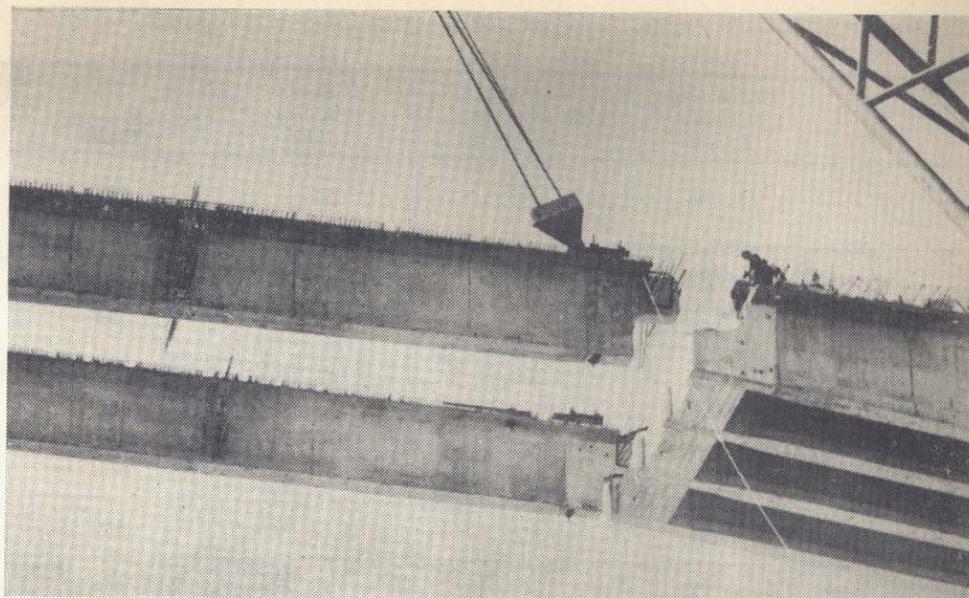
Emplazamiento de una viga prefabricada externa sobre el apoyo. Se observa claramente el extremo de cuatro dobles ménsulas unidas por viga y los cabezales de apoyo, tanto de éstas como de las vigas de 40 m pre-prefabricados según se indica en 2.5.2. También se observan las armaduras para la parte del tablero y diafragmas de arriostamiento transversal, que se hormigonan en sitio.
